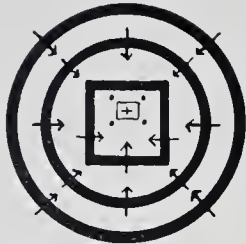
Vierte Kirchen-grundform; Rundbau mit zentralem, einräumigen Allerheiligsten.
